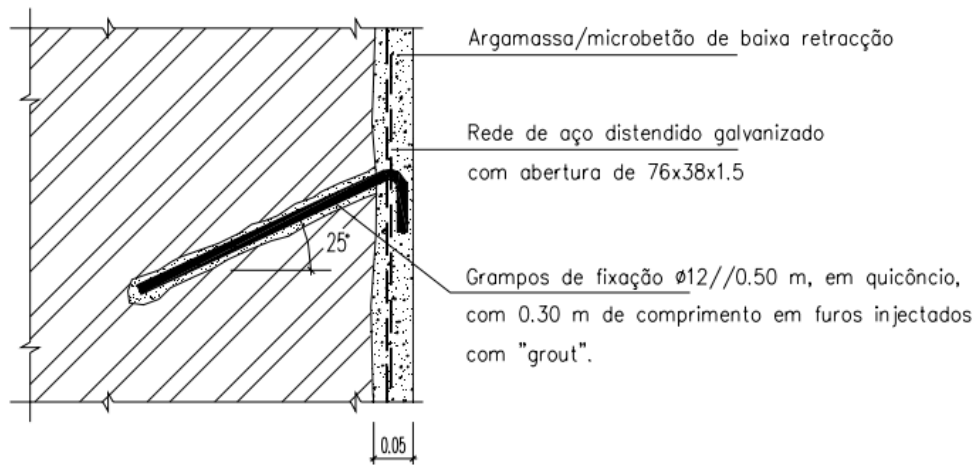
Desenho de pormenor da aplicação da rede em aço distendido na execução do reboco armado (Lamego, 2014)
